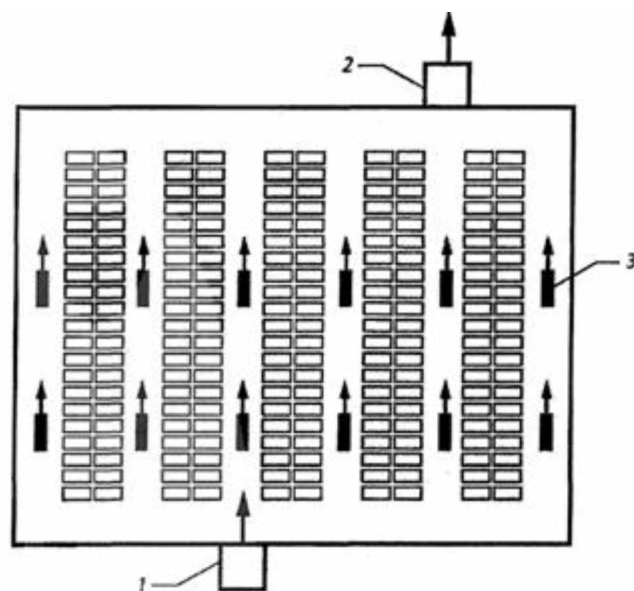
Схема системы струйной вентиляции: 1 - приточная вентиляция; 2 - вытяжная вентиляция; 3 - струйный вентилятор
